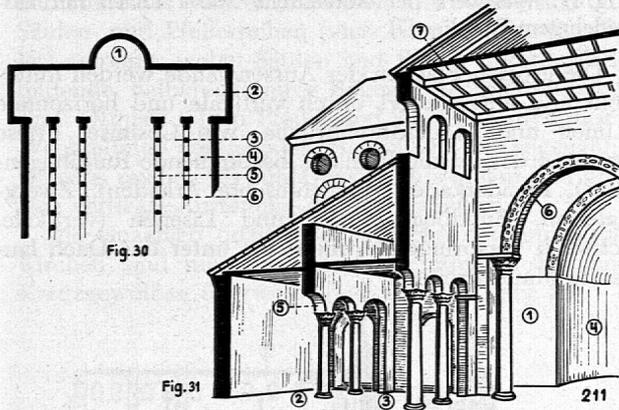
, Fig. 30, zeigt den Grundriss der Langhausbasilika mit Querschiff:
